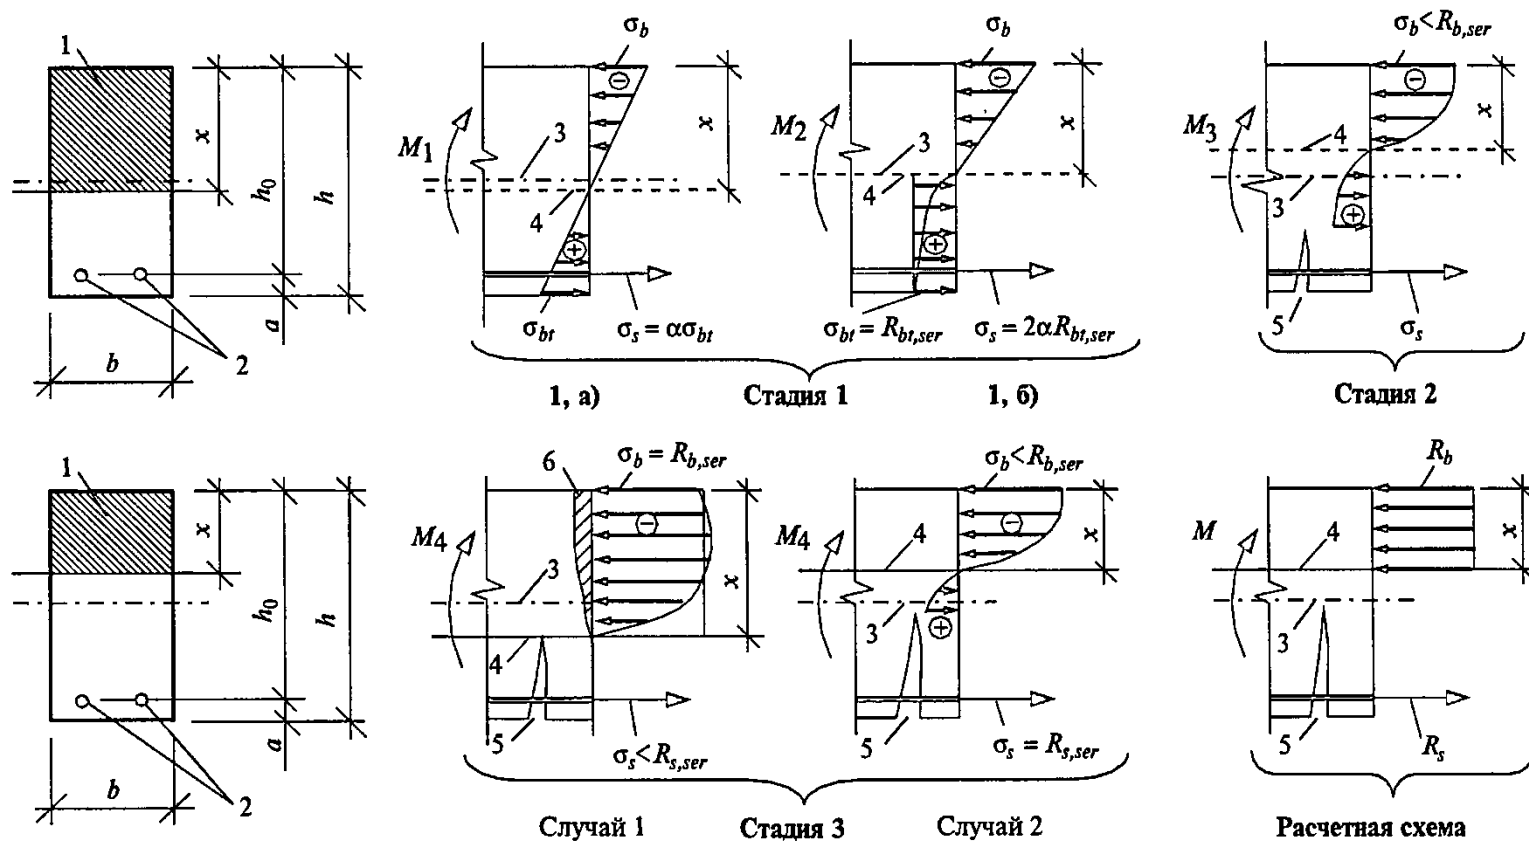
Стадии напряженно-деформированного состояния в нормальном сечении при изгибе железобетонной балки от начала работы до разрушения: 1 – сжатая зона бетона; 2 – арматура; 3 – центральная ось; 4 – нейтральная ось; 5 – трещина; 6 – зона разрушения бетона; M – изгибающий момент: $M_4 > M_3 > M_2 > M_1$
